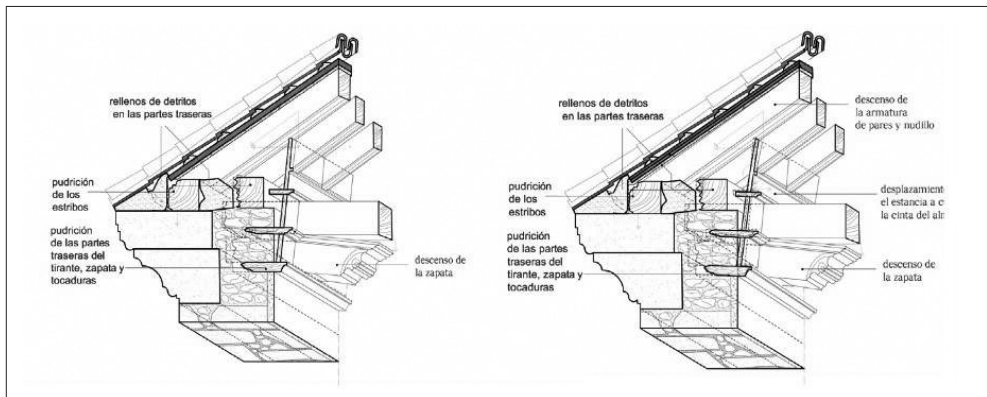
DV1: descenso de las zapatas, puestas en correspondencia con los tirantes dobles de las armaduras apeinazadas de tres paños, presentes principalmente en la planta segunda.
